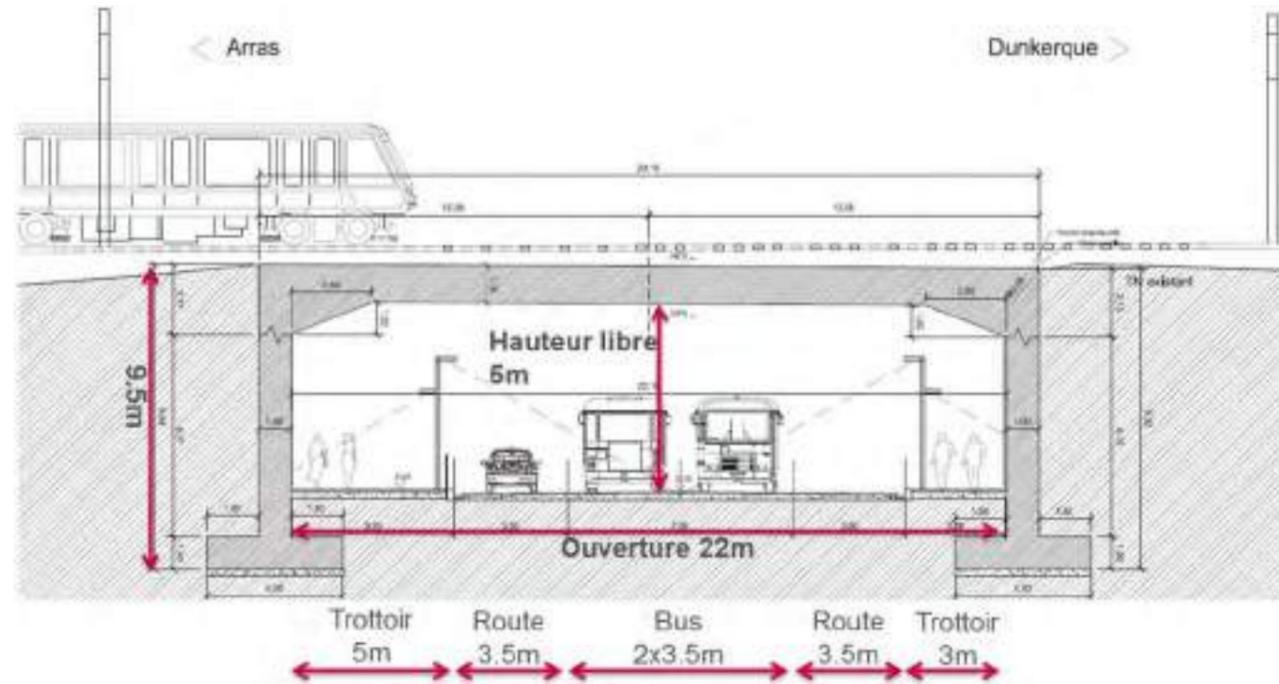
Profil en travers de l'ouvrage– source RFF-SNCF.
